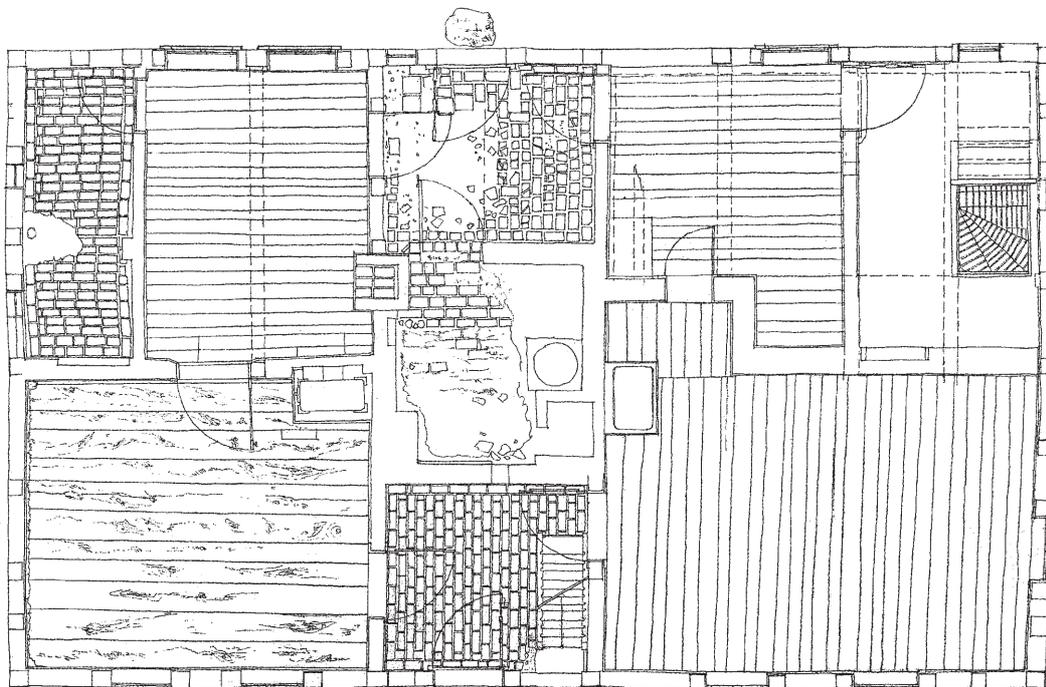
Grundriss einer Scheune in Genauigkeitsstufe II, Maßstab 1:50 mit geringer Informationsdichte
